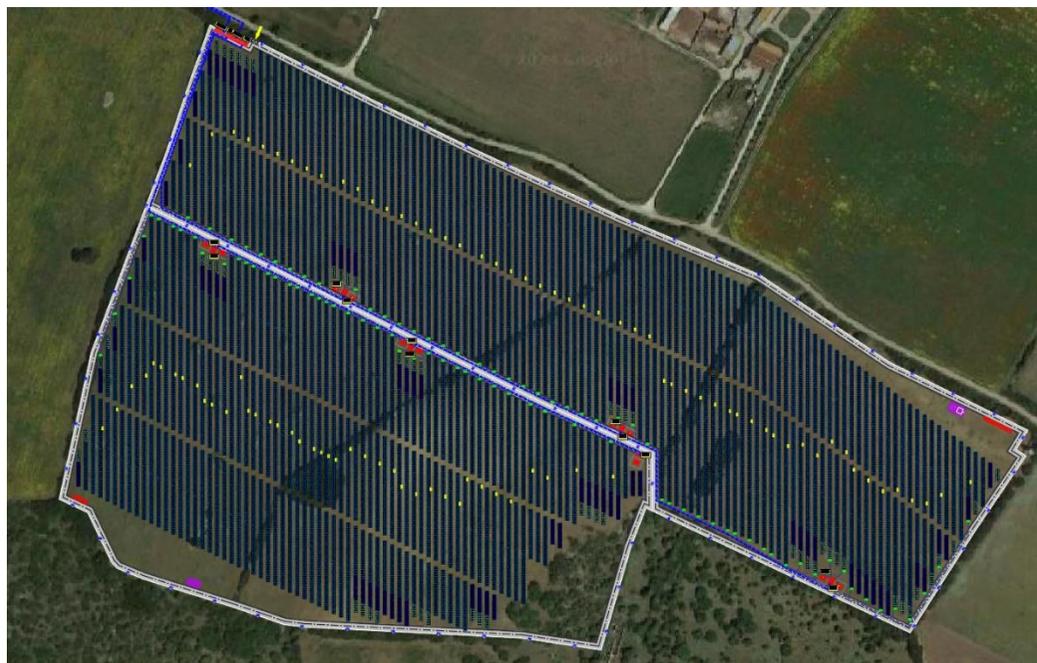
Planimetria impianto lotto 2 (a sinistra) e lotto 3 (a destra) su ortofoto (da elaborati di progetto)
